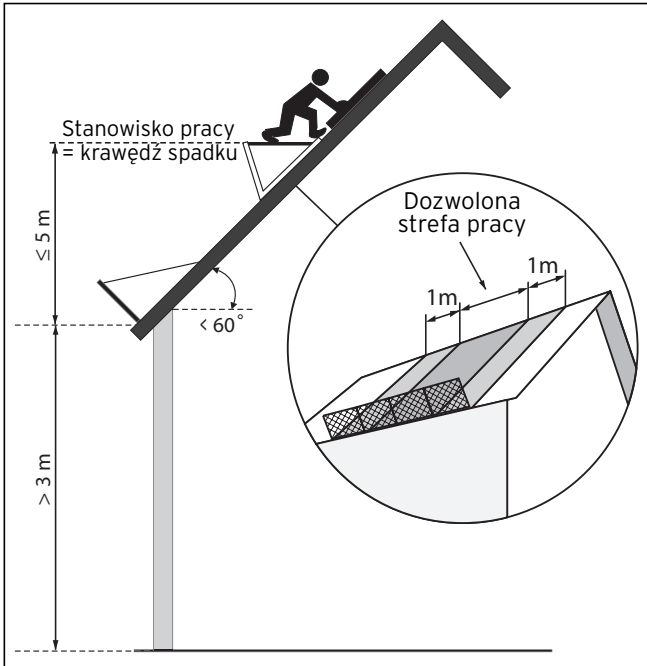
Rusztowania dachowe do prac na dachach pochyłych
